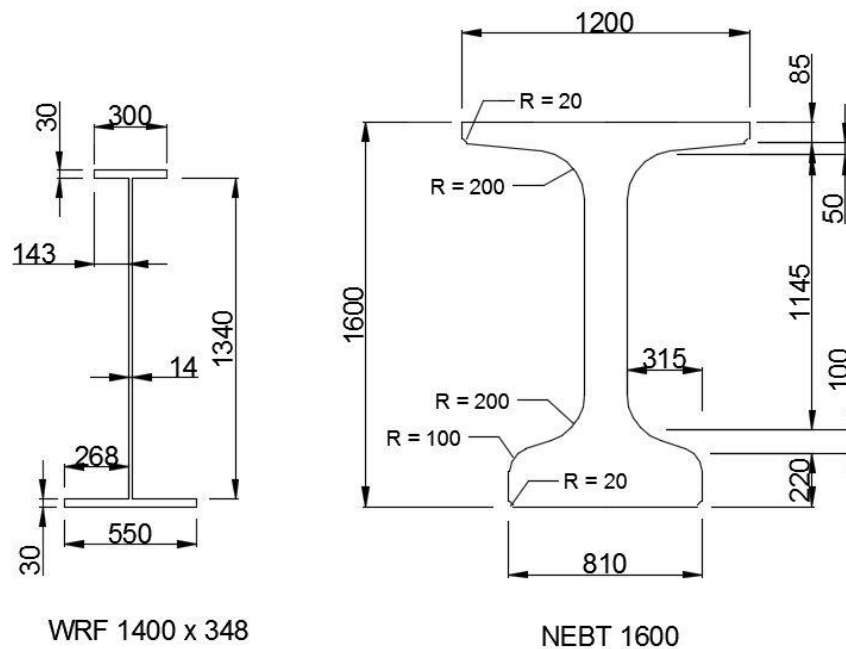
Profilés des poutres d'acier en I et de béton NEBT 1600
